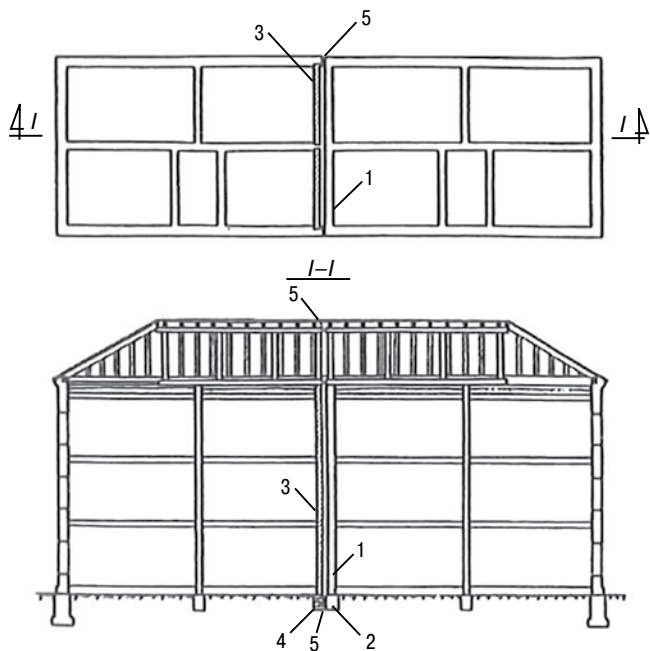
Схема разрезки здания на отсеки: 1 – существующая стена; 2 – существующий фундамент; 3 – вновь возводимая стена; 4 – вновь возводимый фундамент; 5 – деформационный шов
